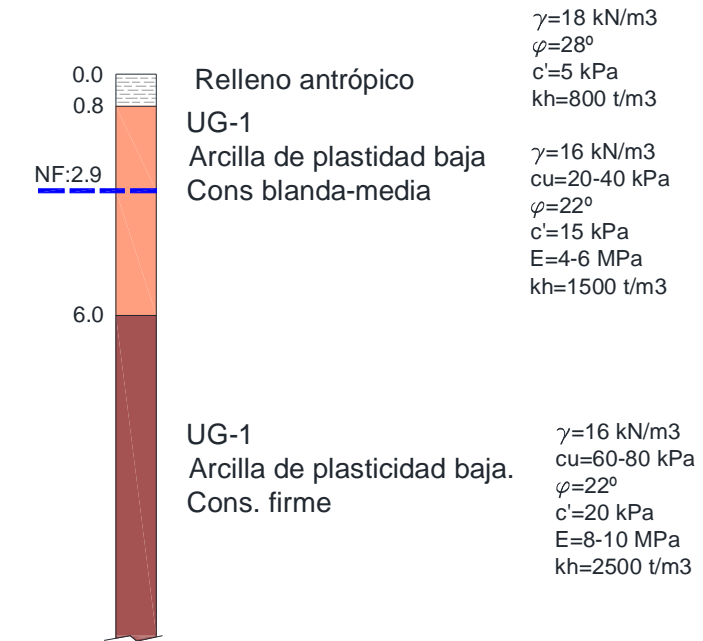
EBAR Secadero. Columna geotécnica de cálculo
